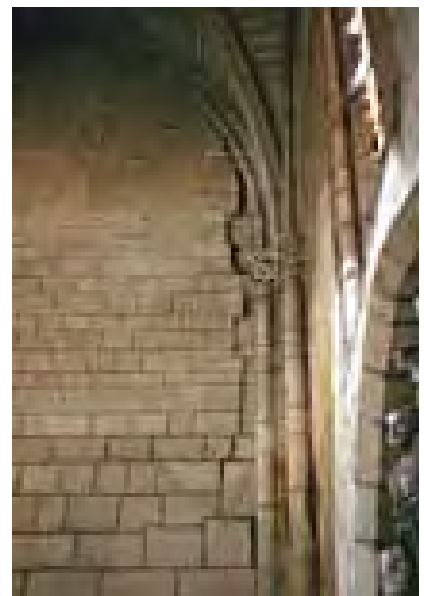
Simétrica a la anterior, grieta en el extremo opuesto del mismo muro, junto al cierre exterior de la muralla, producida por la misma apertura del arco fornero
